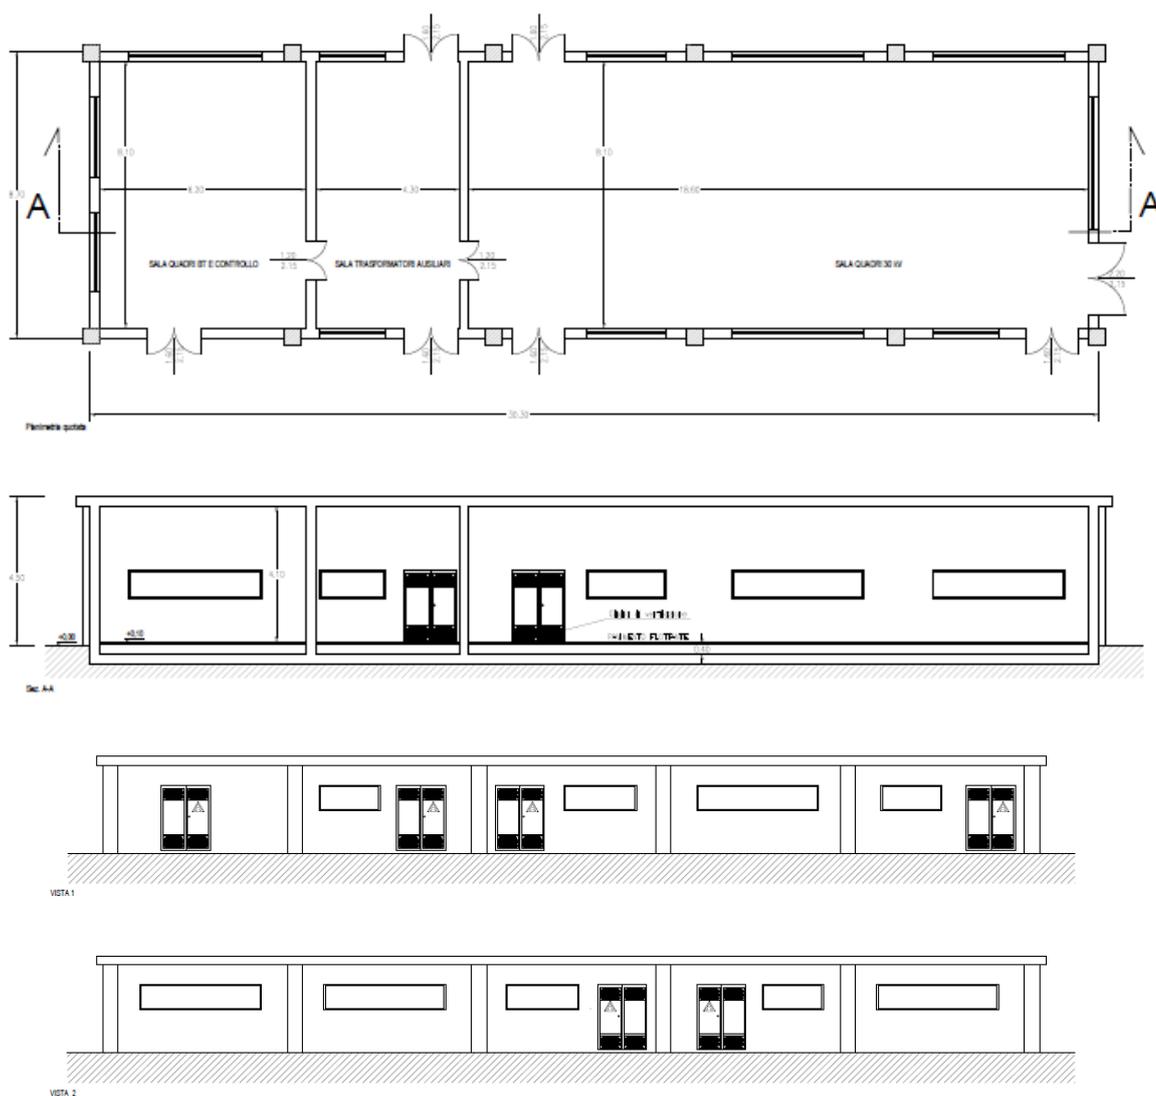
Viste in pianta, sezione e prospetto cabina di connessione
